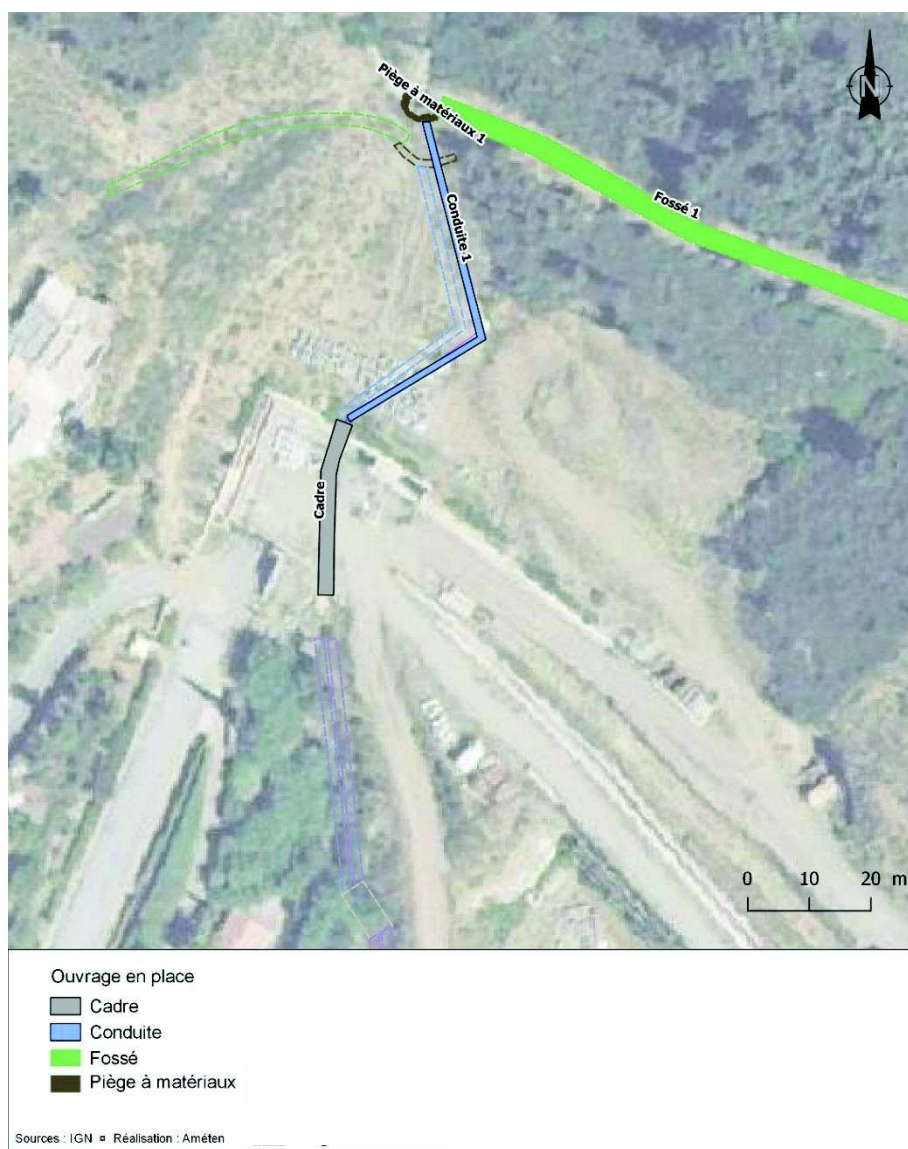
Ouvrages hydrauliques en place au droit du projet
